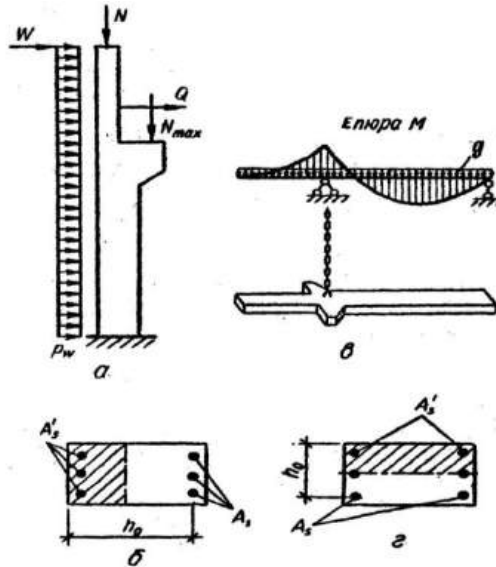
До розрахунку збірних конструкцій в стадіях експлуатації, транспортування і монтажу: *a* – розрахункова схема колони в стадії експлуатації *б* - армування перерізів у стадії експлуатації; *в* – розрахункова схема колони в стадіях транспортування і монтажу; *г* - армування колони в стадіях транспортування і монтажу
